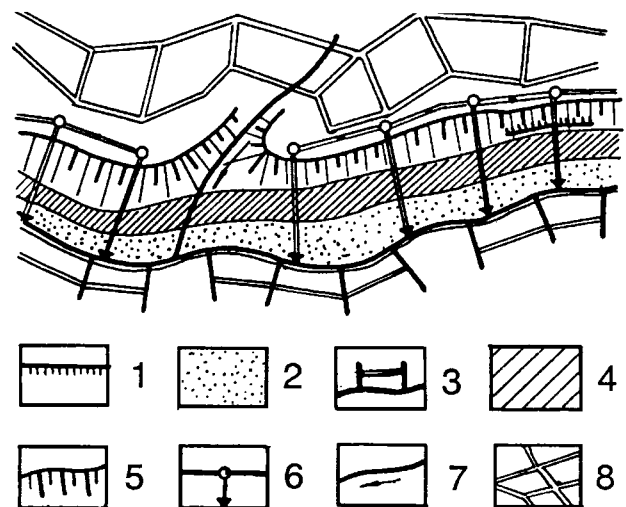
Схема протизсувних заходів: 1 – абразивні ділянки; 2 – берегозахисні споруди; 3 – намівання пляжів; 4 – хвилевідбійна стіна; 5 – планування і закріплення схилів; 6 – дренаж; 7 – водостік; 8 – територія забудови
